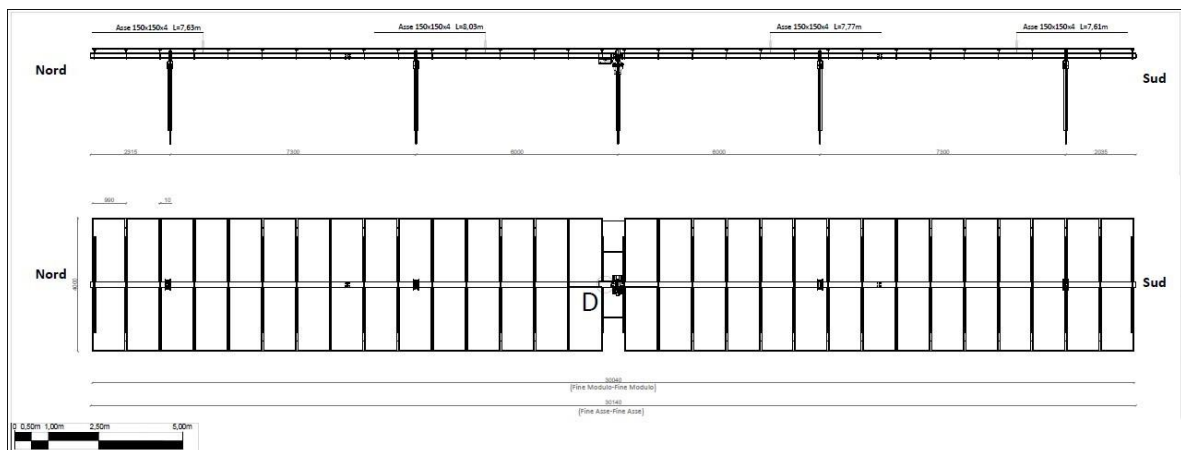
Particolare vista in sezione e in planimetria delle strutture
